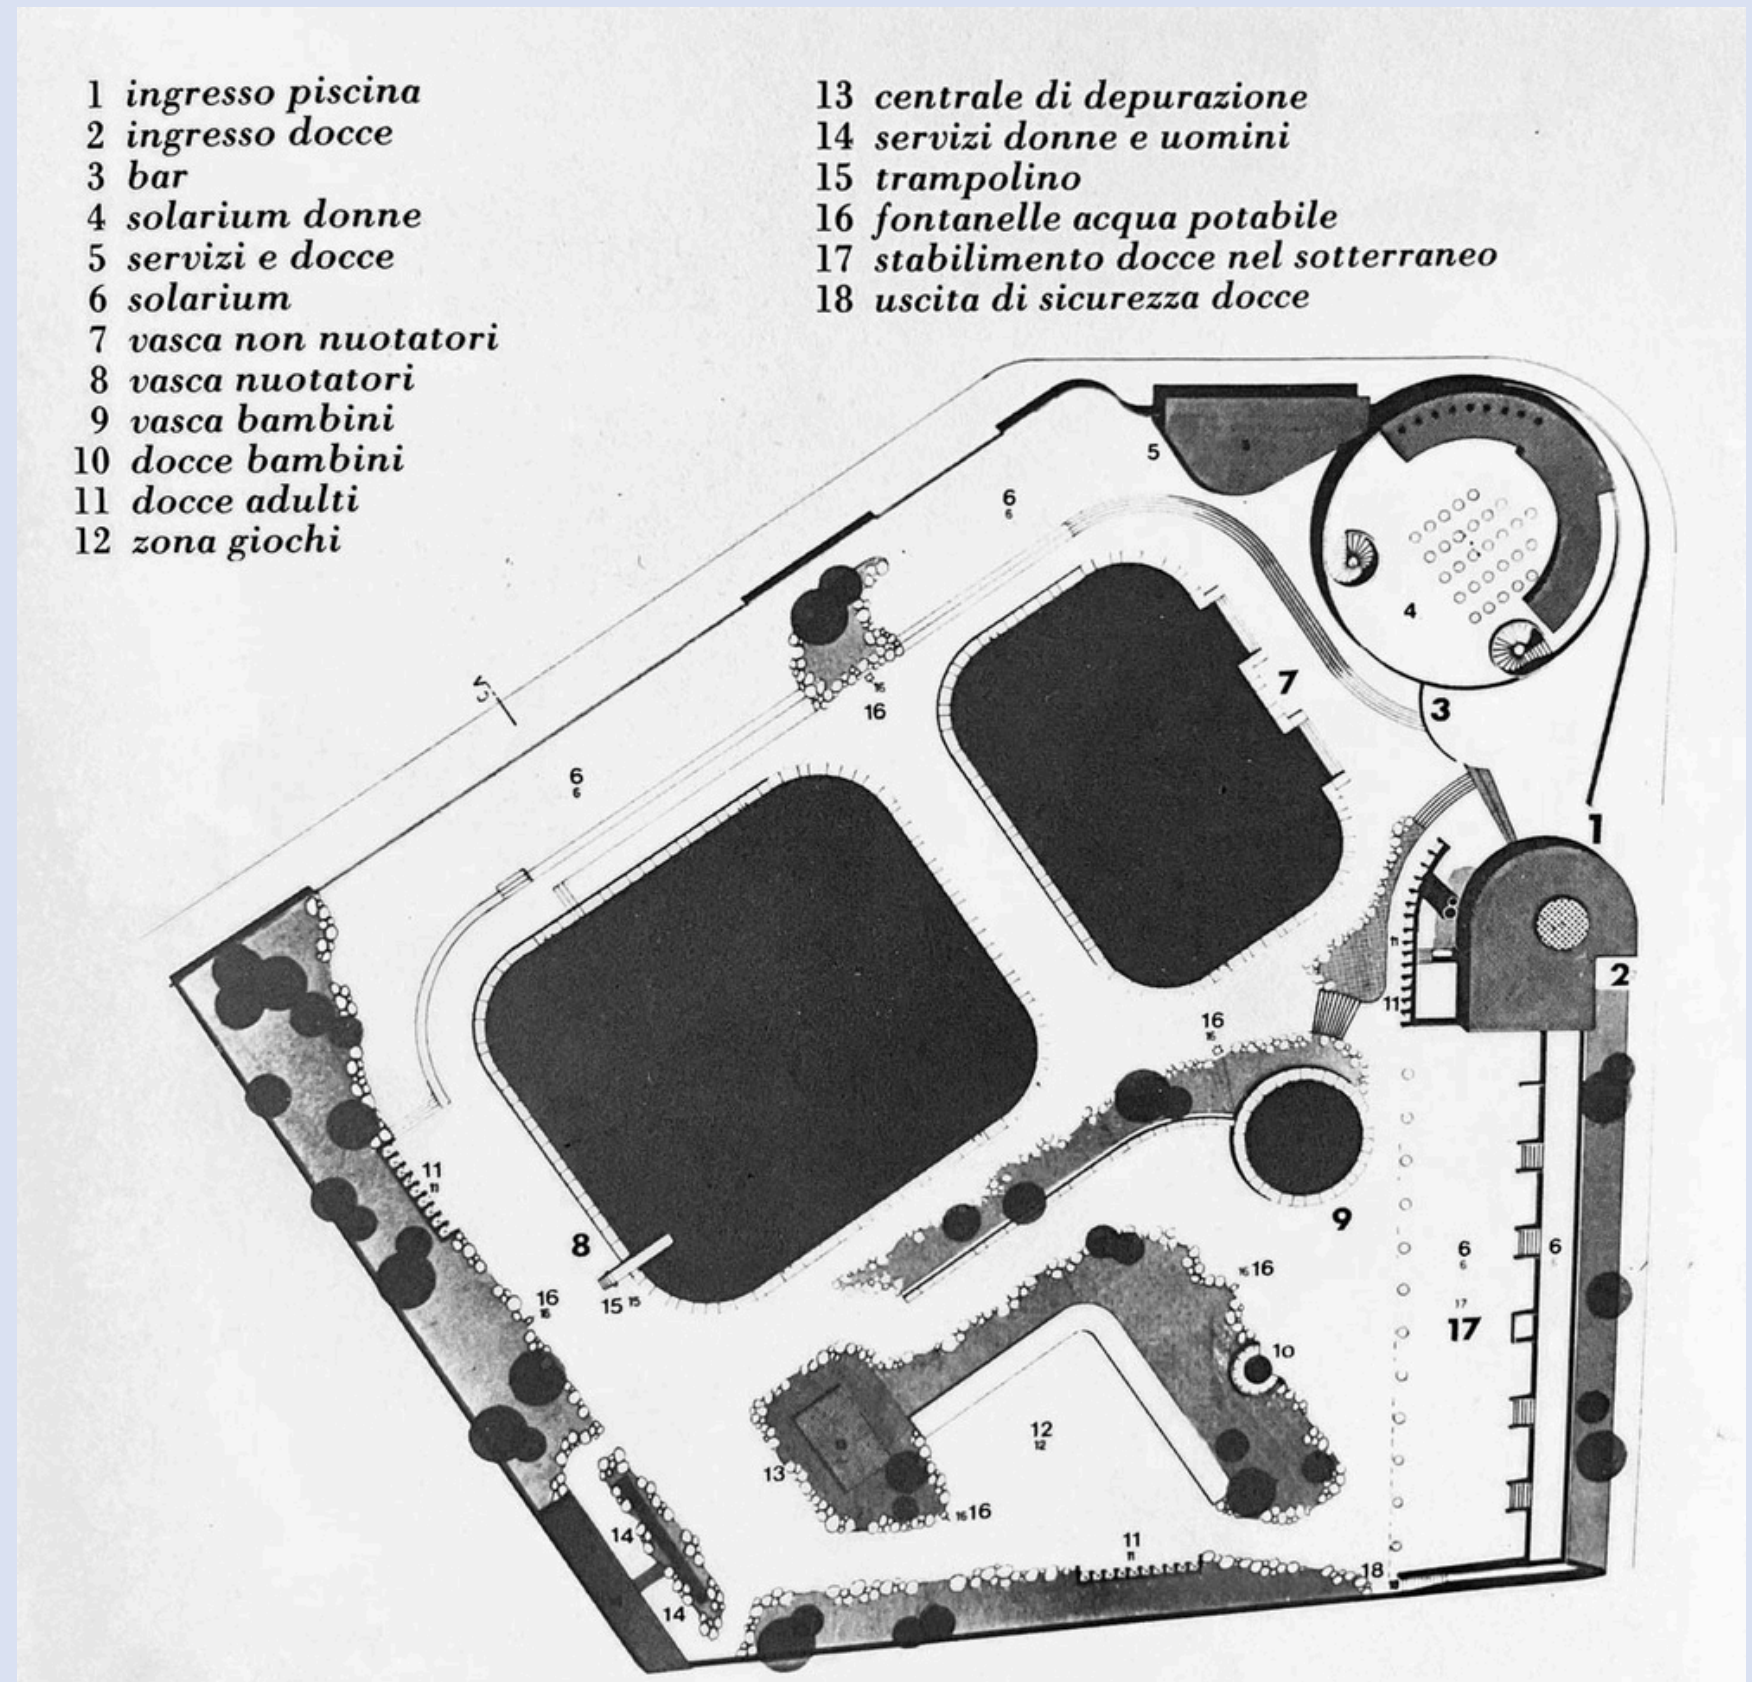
Planimetria di Piscina Argelati disegnata dall'architetto Arrigo Arrighetti
